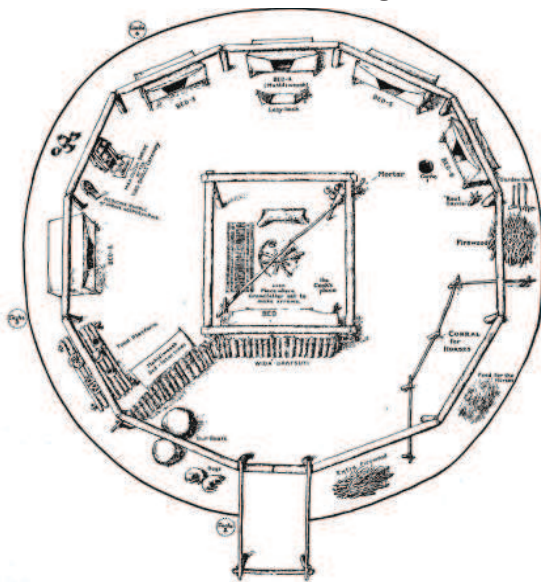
Grundriss einer Mandan Erdlodge mit schematischer Raumaufteilung
